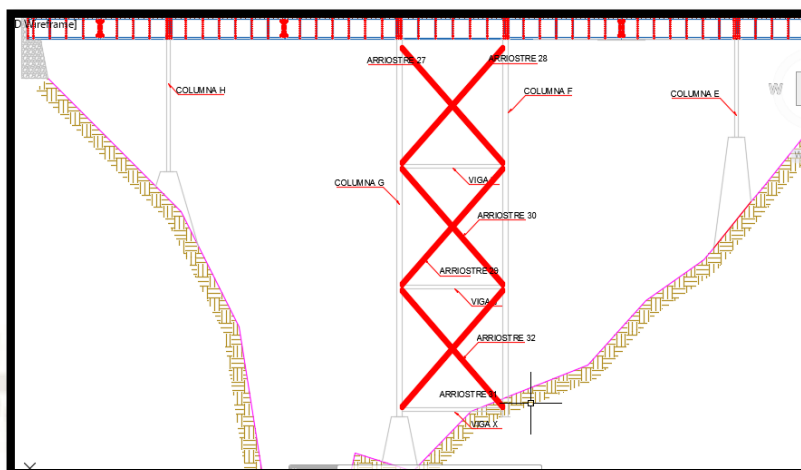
Columnas y arriostres de Torre 2 – Elevación lateral hacia A. Abajo a reforzar.
